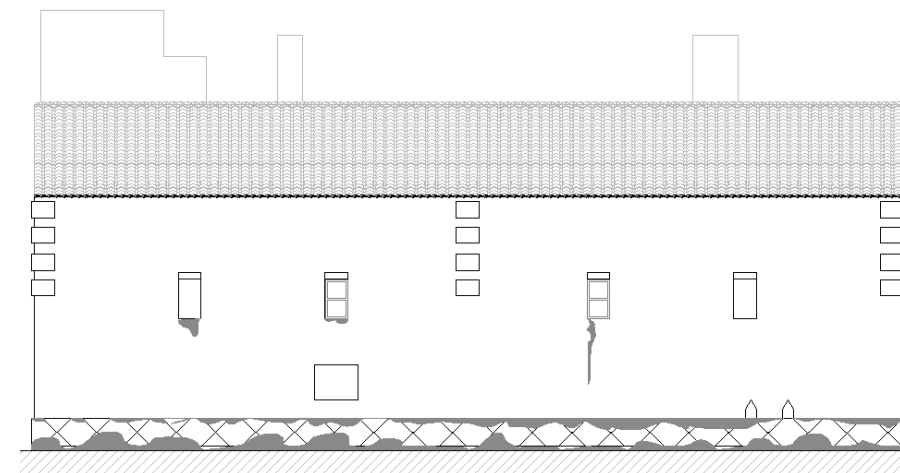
Plano Fachada exterior Nord-Oeste (Fuente propia)
